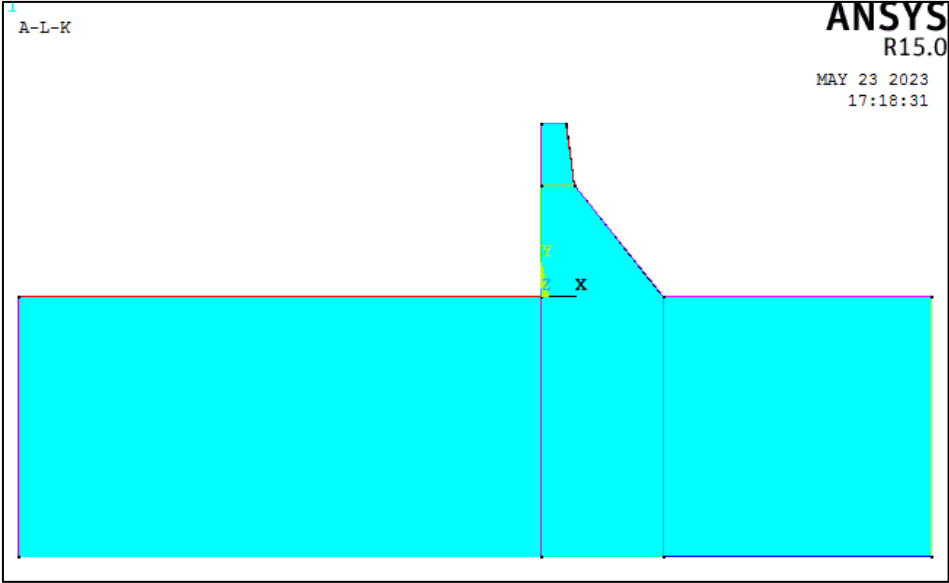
Section du barrage-fondation de Koyna sur ANSYS
